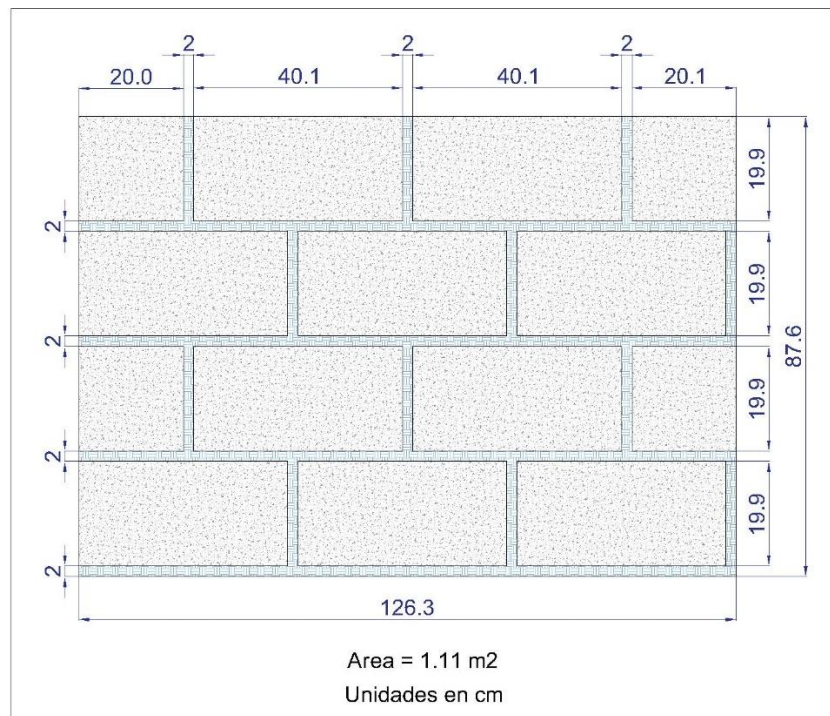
Unidad de análisis para mampostería de bloque de hormigón prensado
